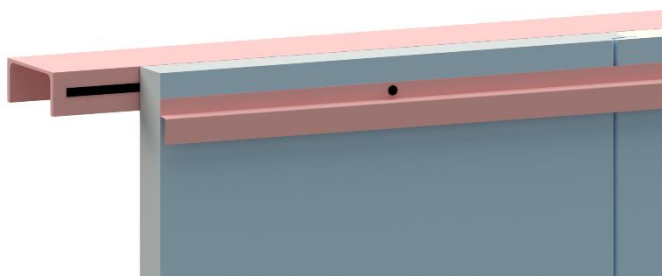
Exemple d'un parement extérieur de la typologie 4 sur double réseau de profilés avec panneaux sandwich isolants posés horizontalement.
